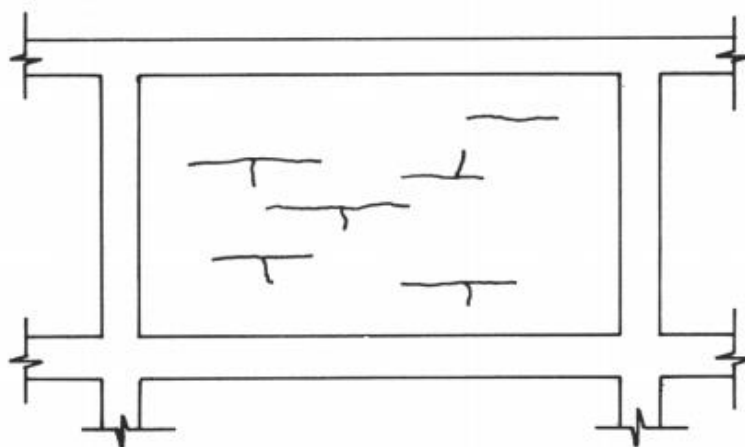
Fissuras horizontais na alvenaria (THOMAZ, 2020).
